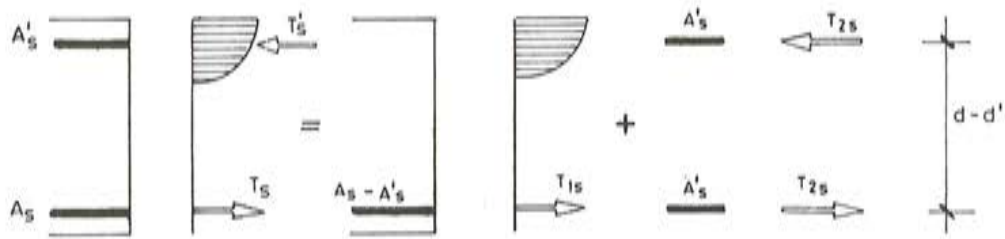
Método aproximado de cálculo para secciones con armadura de compresión.
